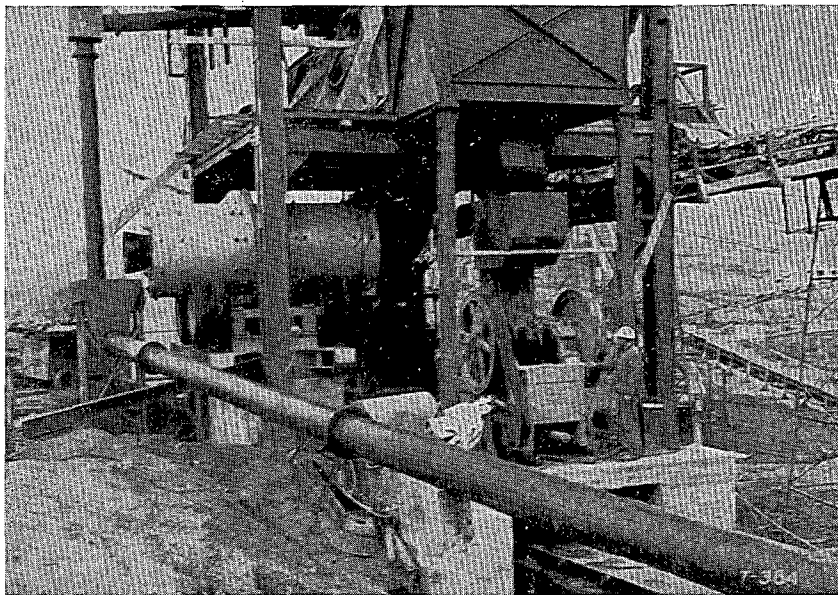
Detalle de la planta de máquinas de machaqueo.
